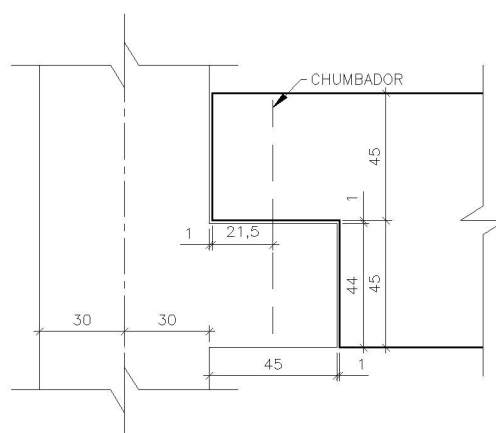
Esquema da extremidade da viga VR01, apoio no consolo do pilar.
